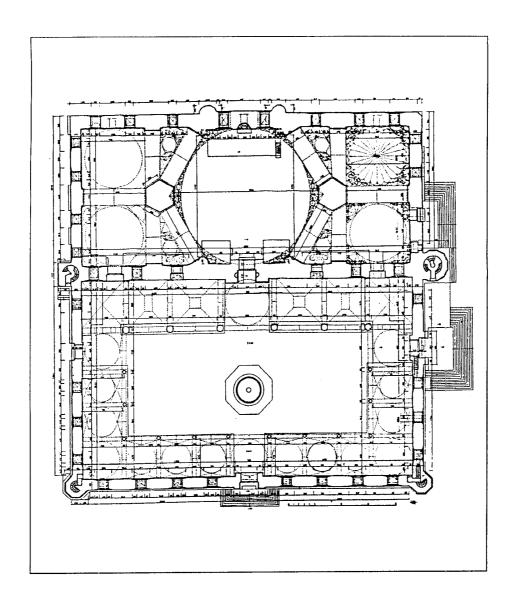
مسقط أفقي للمسجد العتيق (اسكى جامع) في يامبول (عن : كيل) .
